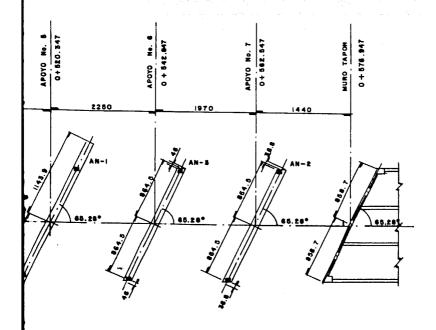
PLANTA DE APOYOS DE PUENTES.
